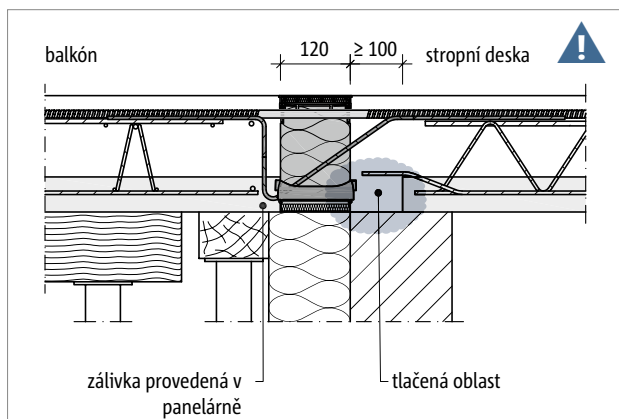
Schöck Isokorb® CXT typ KL: Prefabrikovaný balkón, jehož spodní hrana je snižena vůči stropní desce uložené na předem vybetonované železobetonové stěně
